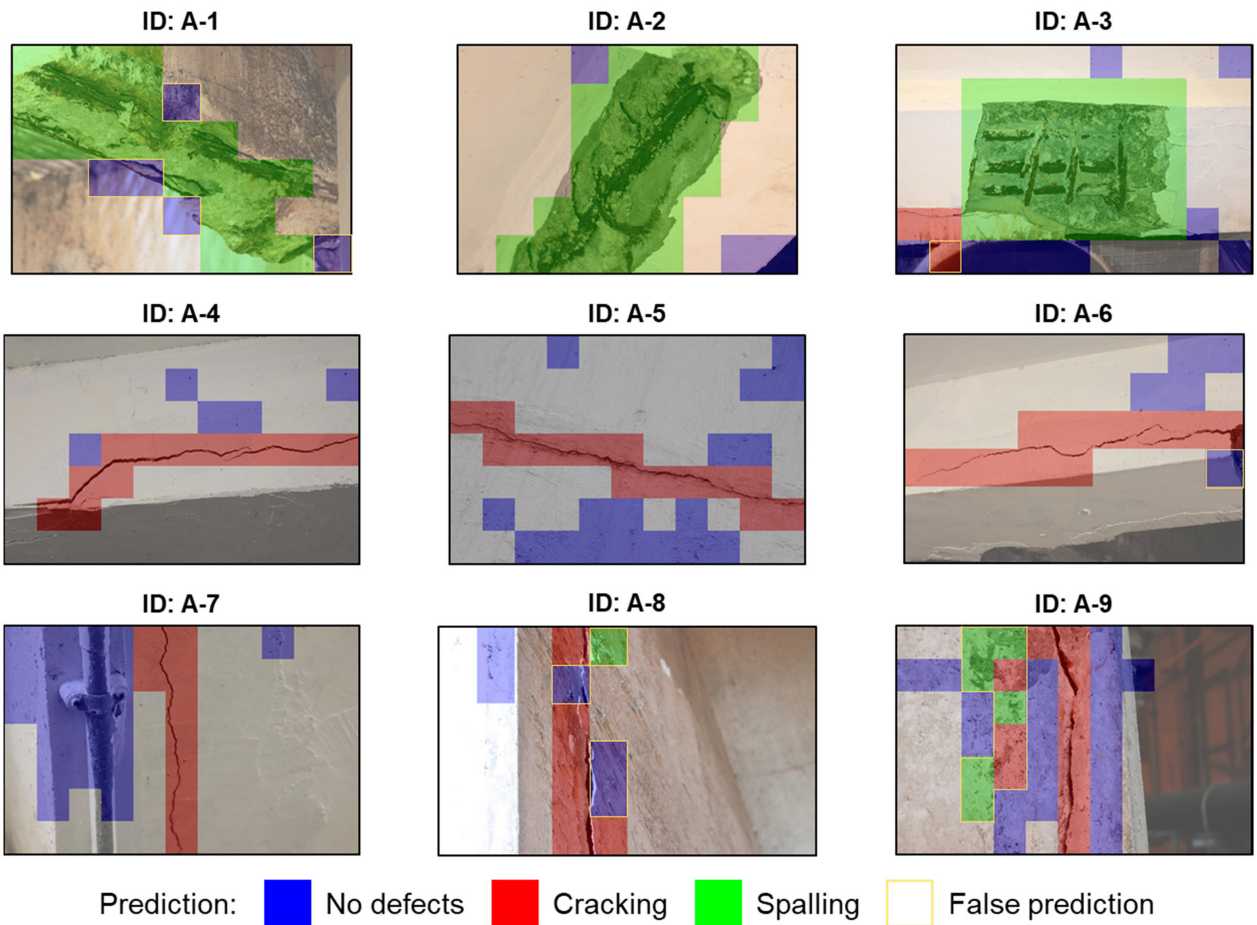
Identificación de grietas en estructuras de homrigón. Fuente: [2].
